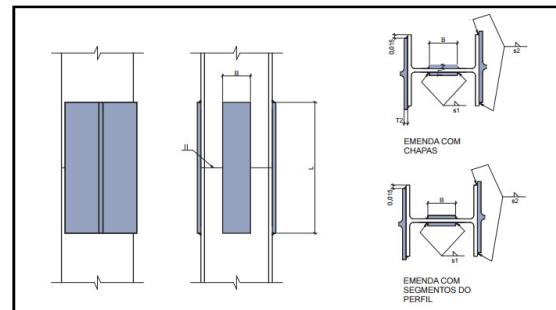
Detalhe da emenda com o posicionamento das talas e soldas (Gerdau)
